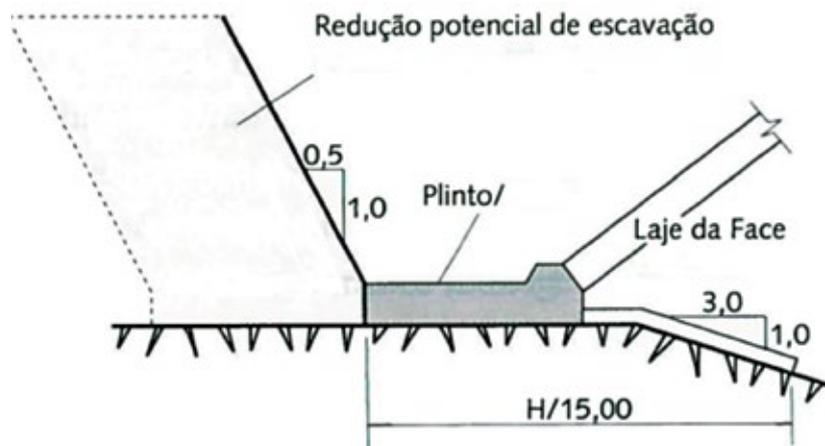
Seção da laje do plinto de montante e jusante (interno).
